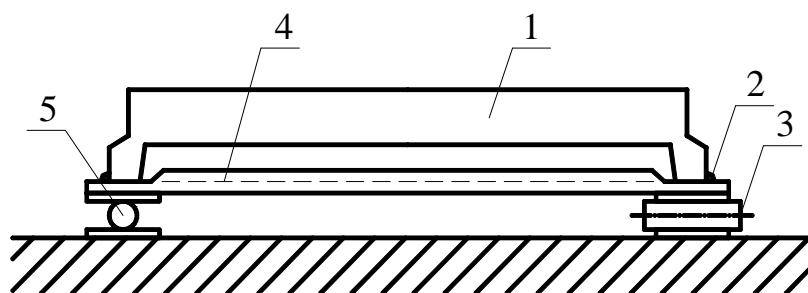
Опирание ребристой плиты: 1 – испытываемая плита; 2 – сварной шов; 3 – каток; 4 – затяжка из швеллера; 5 – шар
